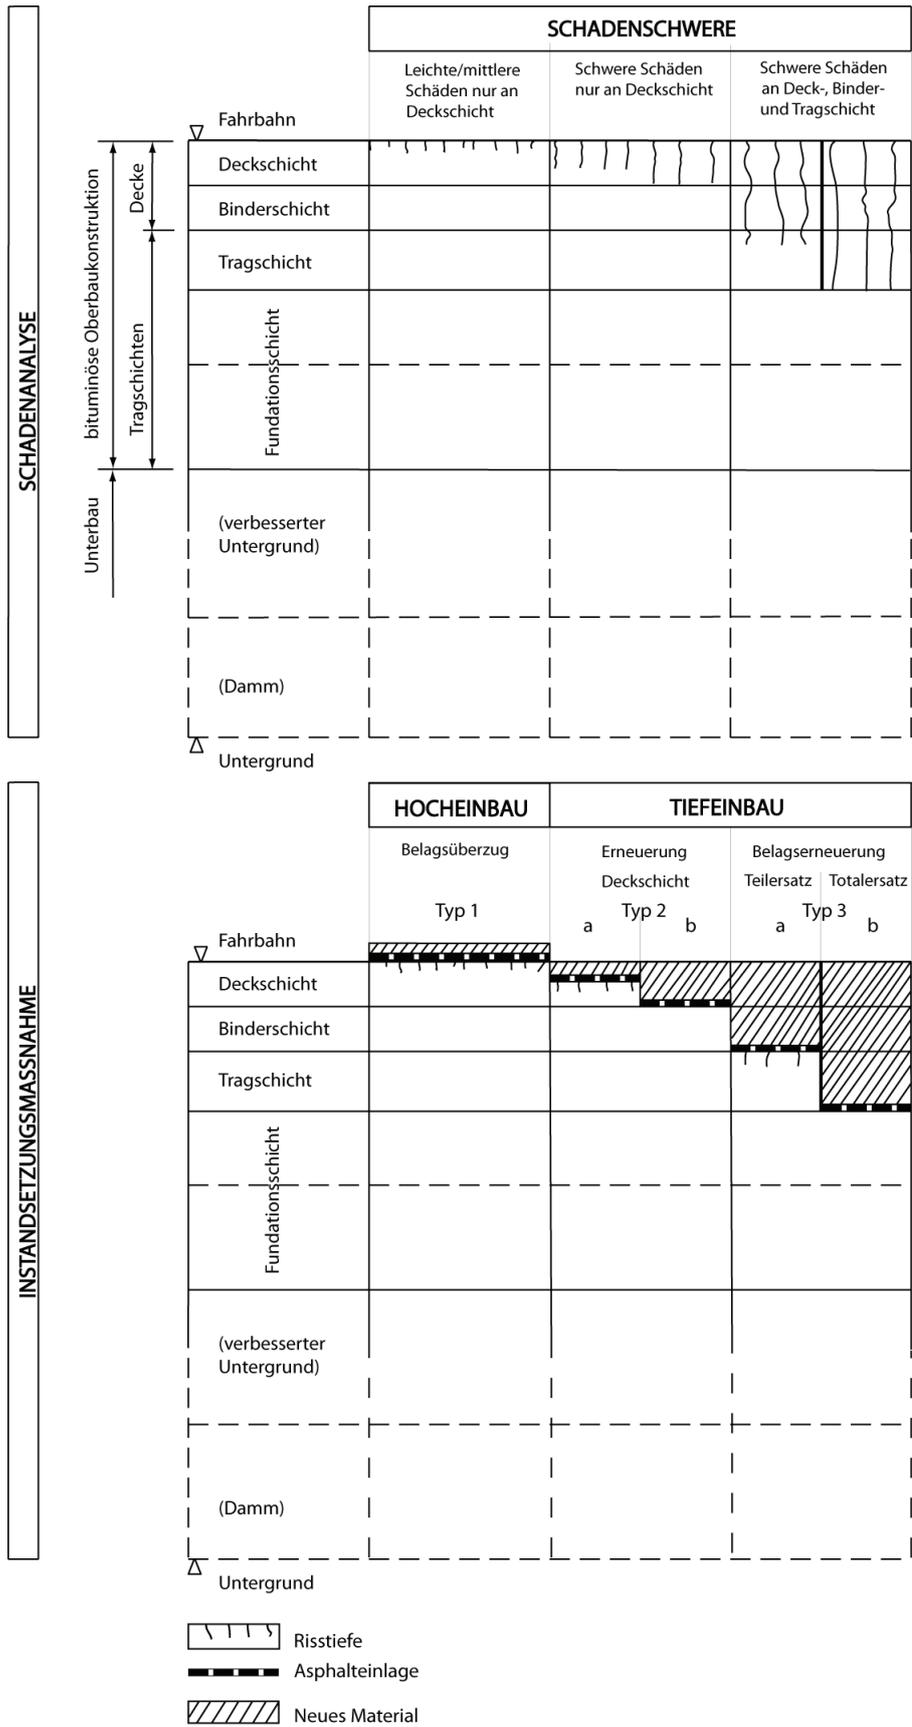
Darstellung der Lage der Asphalteinlage mit Hilfe des typisierten Strassenoberbaus des ASTRA
